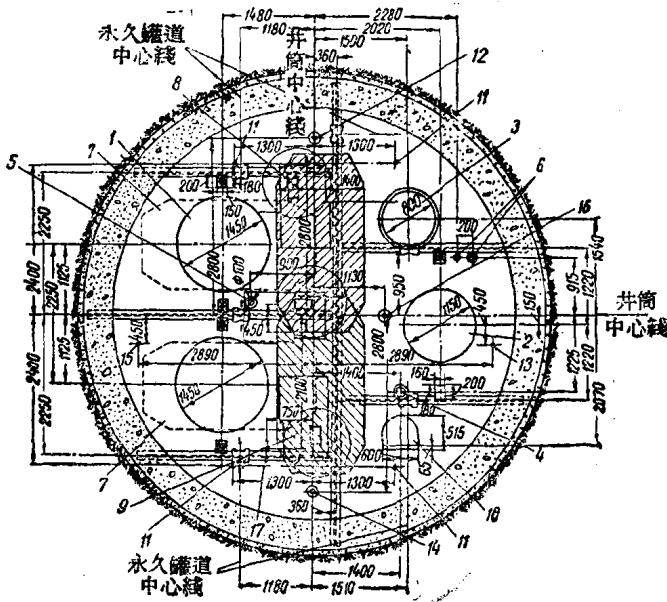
用快硬混凝土筑井壁时，井筒里施工设备的布置
